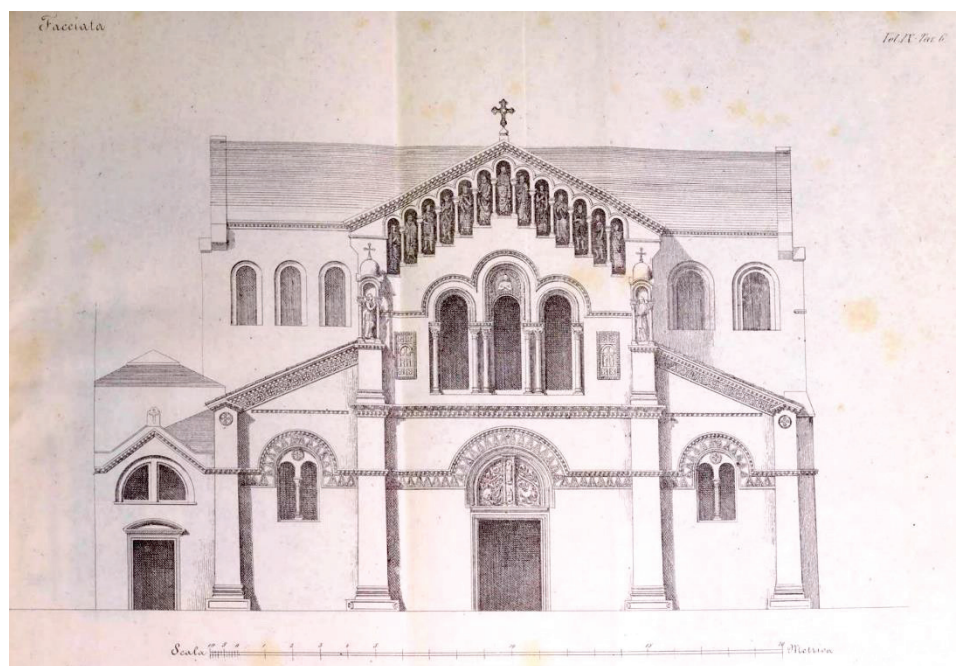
Projeto de restauro para a Basílica de Santa Maria e São Donato, em Murano, Itália. Elevação da fachada frontal.
